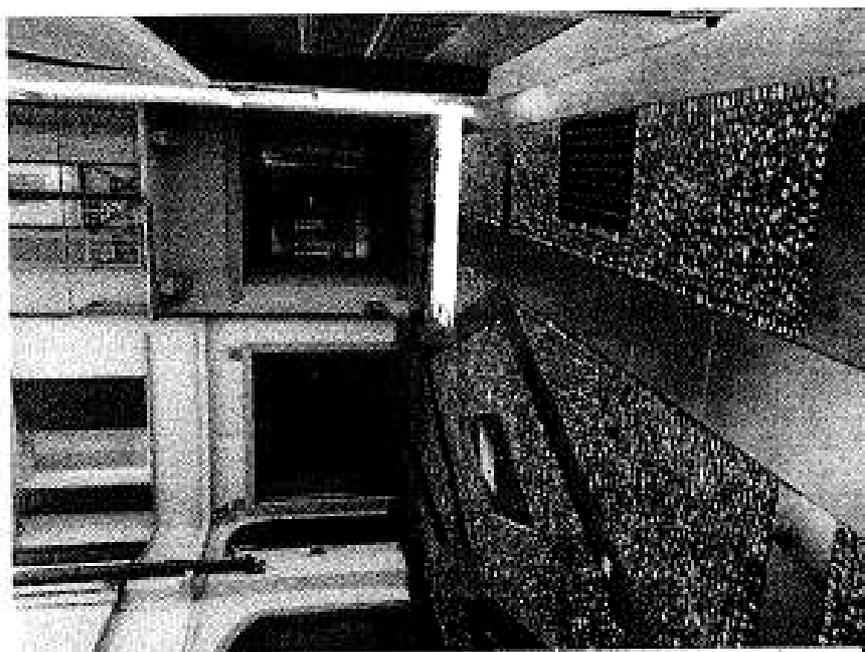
Vista del corsello di ingresso e di manorra e del parcheeggio privati
